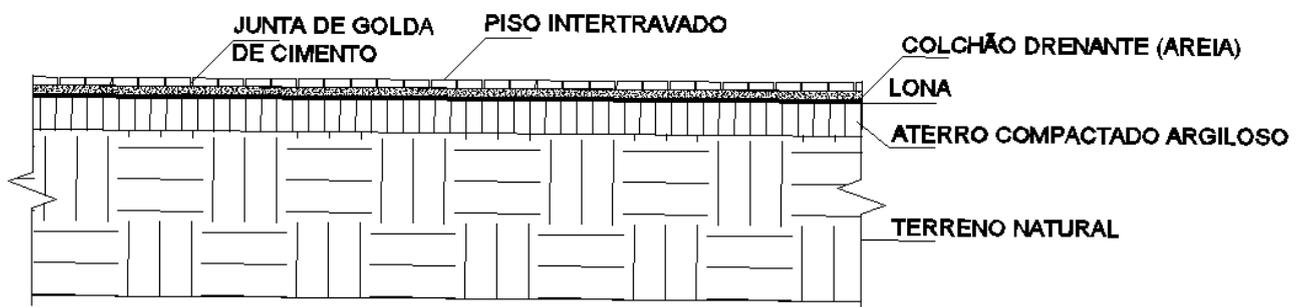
Perfil do piso intertravado instalado no paisagismo.
